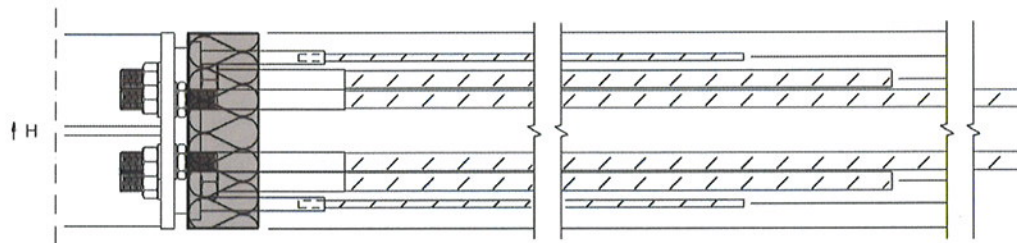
Grundriss Isopro Typ SBM20 Q10 und SBM20 Q12
